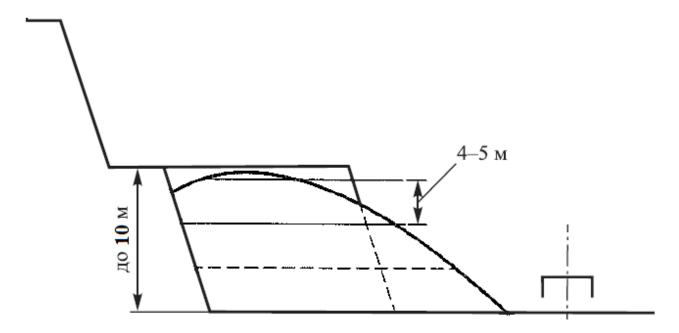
Схема послойной отработки развала экскаватором «обратная лопата»
